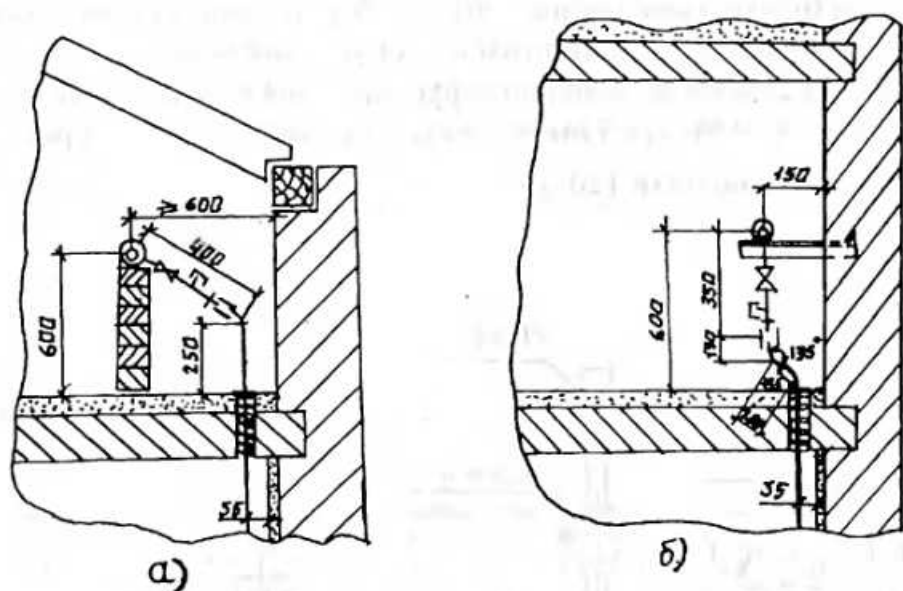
Схеми приєднання стояків до розвідних трубопроводів, що прокладені по горищу: а) з похилим дахом; б) з плоским дахом
